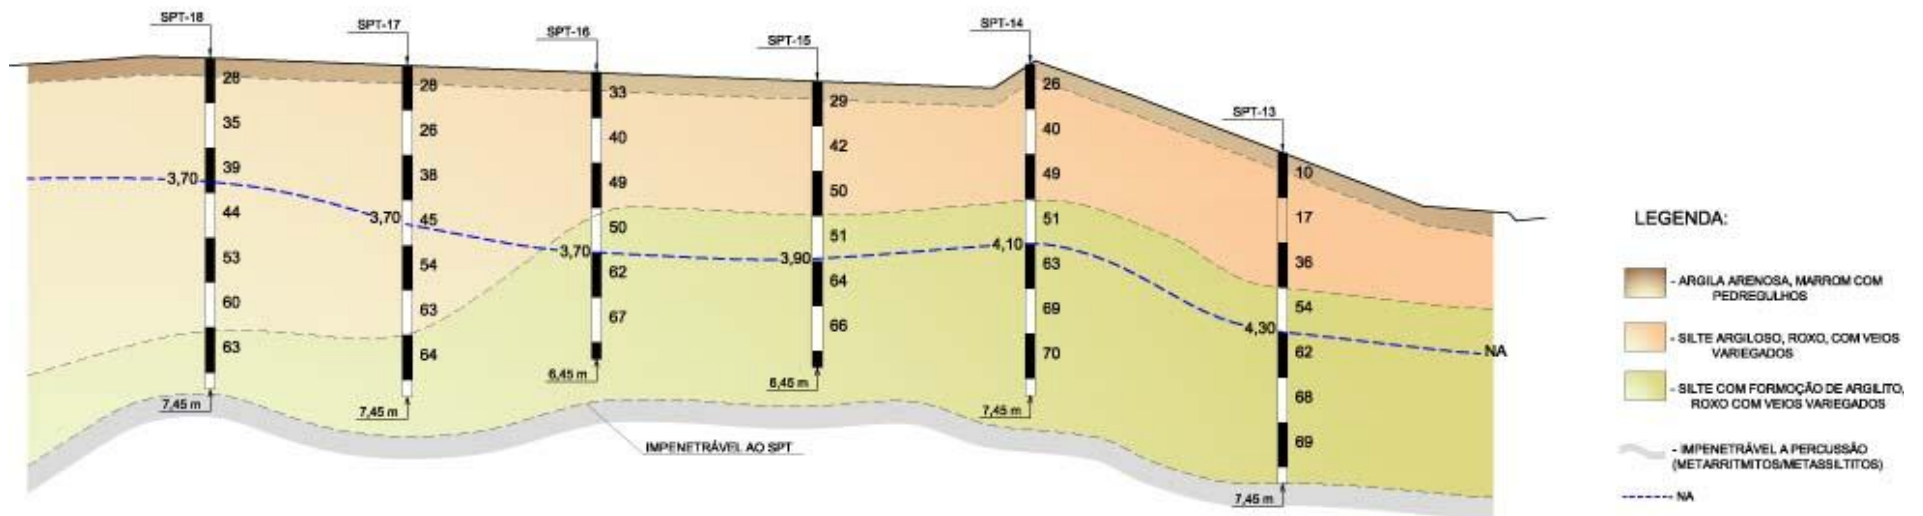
Perfil esquemático (SP 13 a SP 18)
